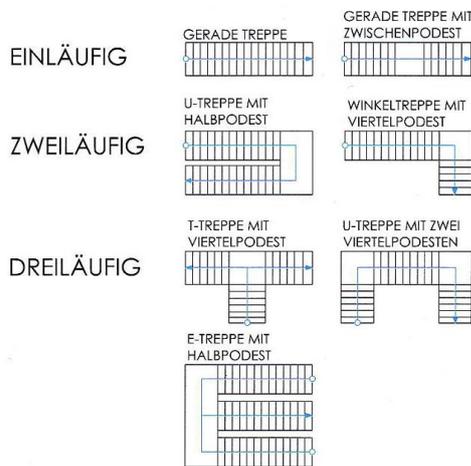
Grundrissformen von Treppen¹⁹²
